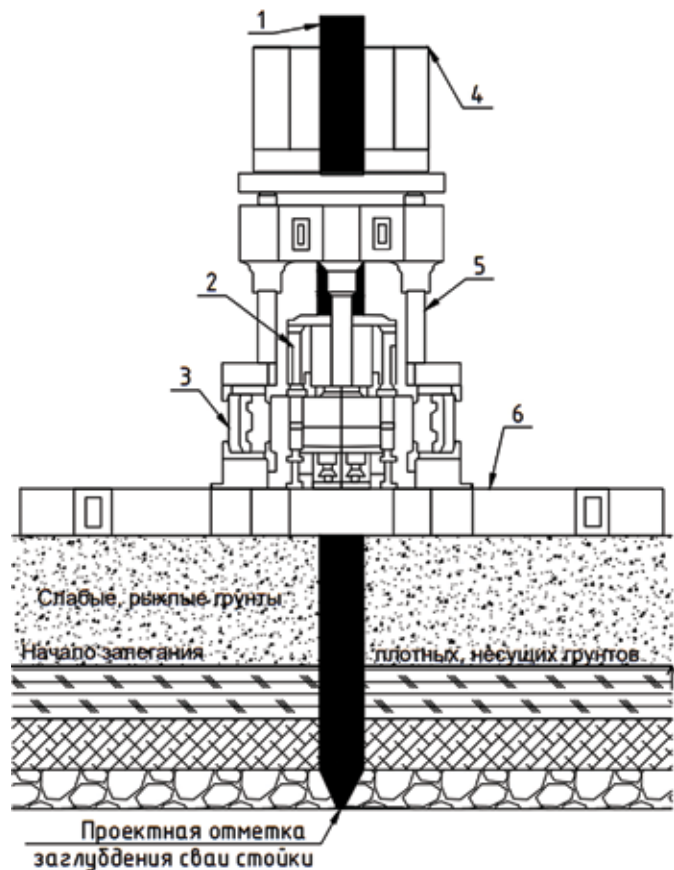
Схема устройства конструкции сваевдавливательной установки СО-450 с послойным разграничением грунтов площадки строительства: 1 – вдавливаемая свая, 2 – система бокового клинового захвата; 3 – вдавливающая головка, 4 – верхнее ограждение; 5 – гидроцилиндры, 6 – грузовая рама
